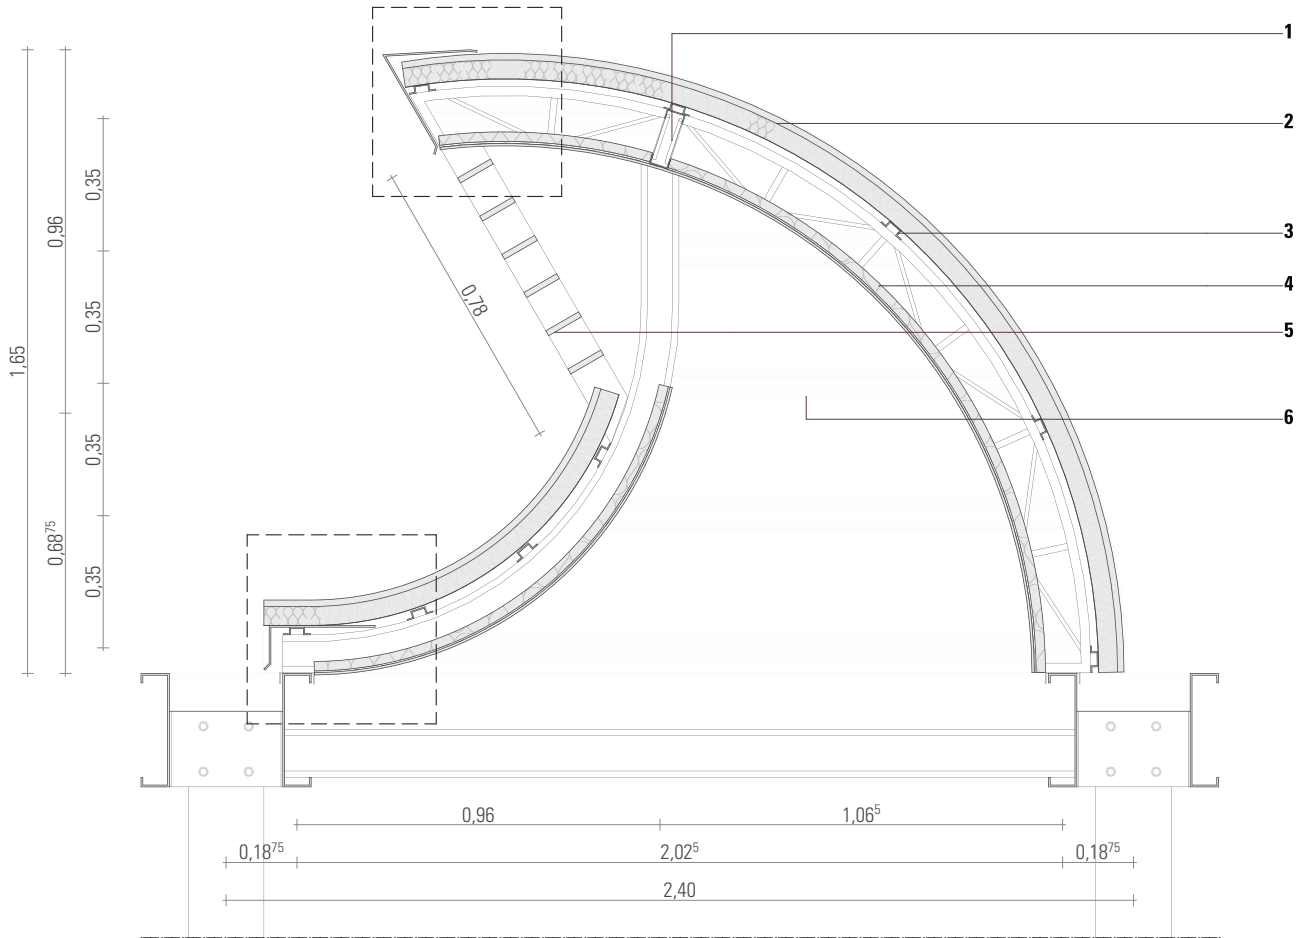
Corte detalhado do shed, em escala 1:20.
